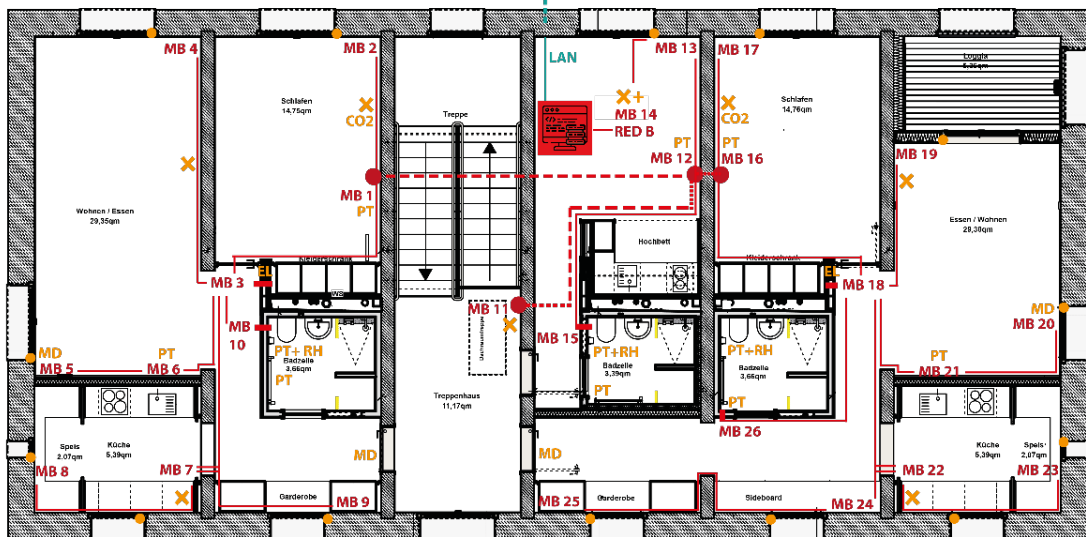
Sensorplan nach SKS; Grundrissplan 2.OG Leichtbetonhaus (links: Norden)
